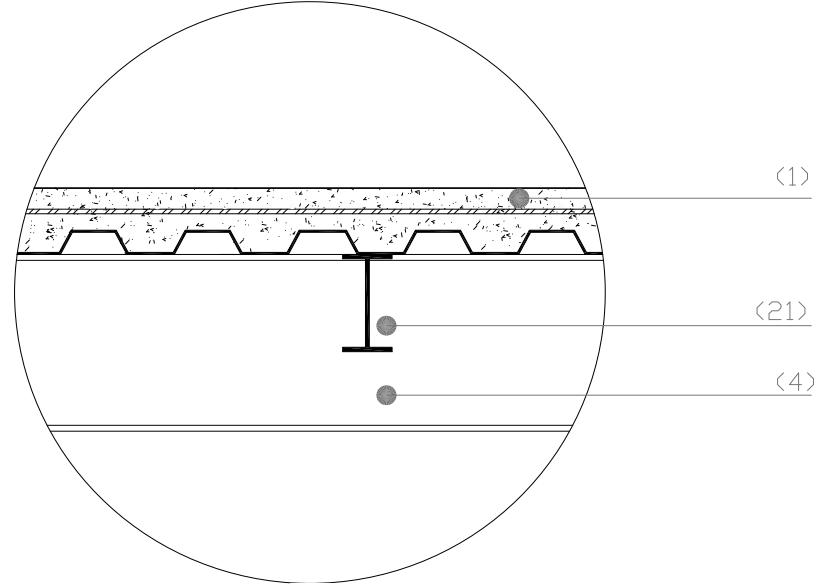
Corte 1 - 1' - Sección Corte Fachada
